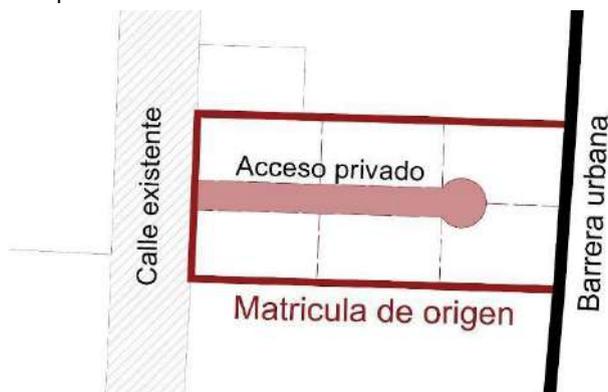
Ejemplo de acceso privado en sectores con barrera urbana.
